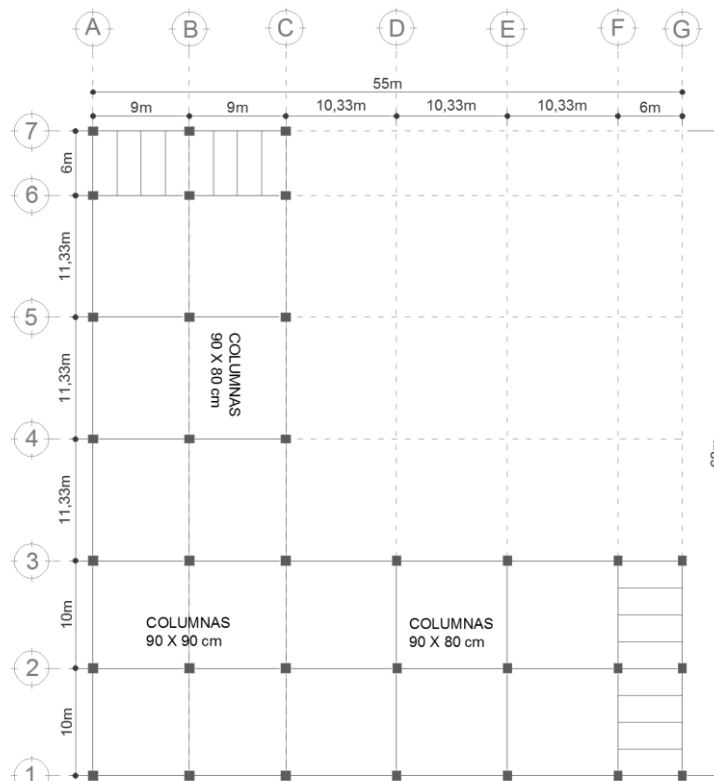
Columnas propuestas del nivel 5 al 7 para la estructura de concreto.
